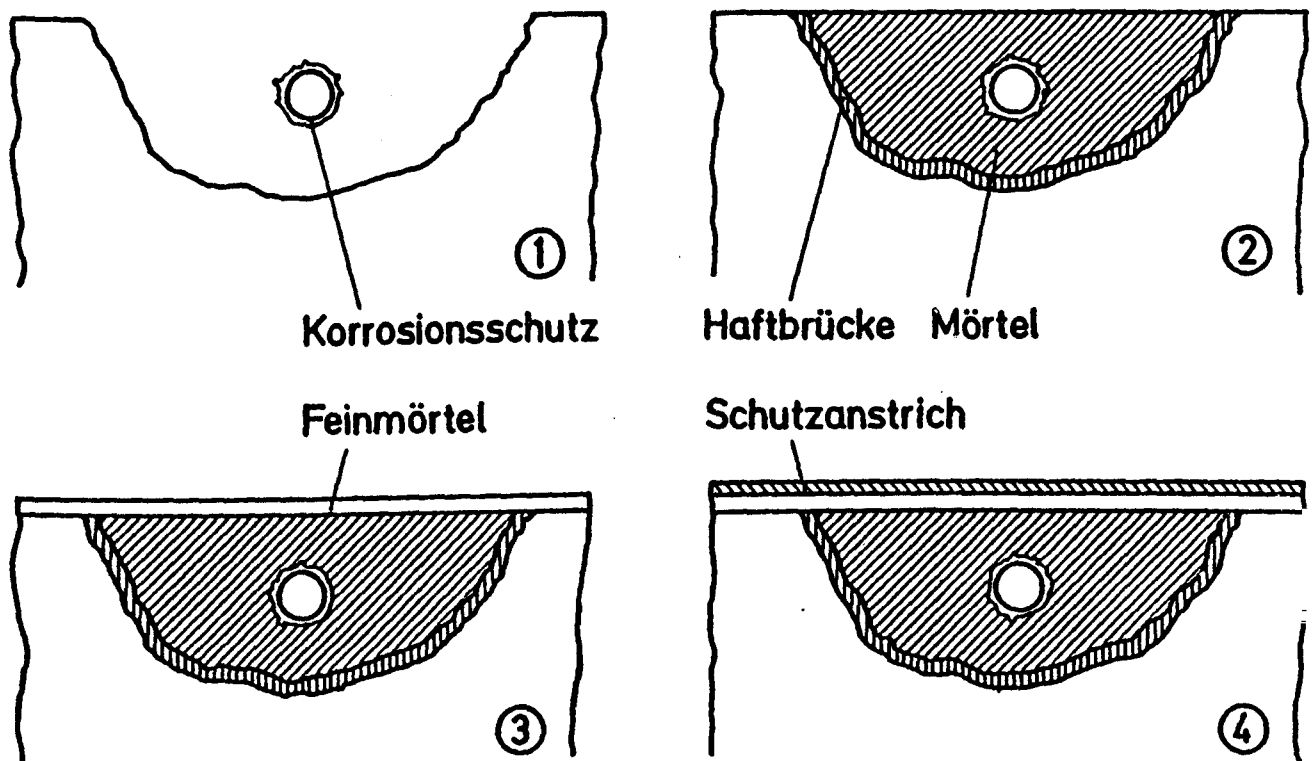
Arbeitsschritte einer üblichen Betonoberflächen-Instandsetzung nach Schäden infolge korrodierender Bewehrung
